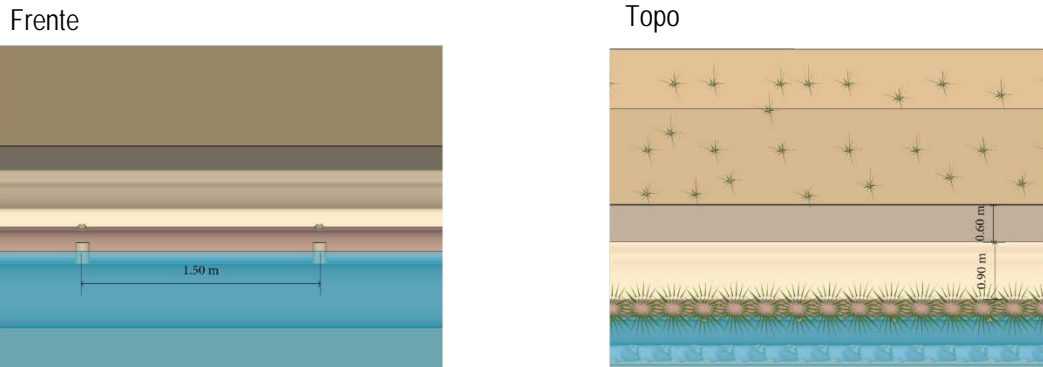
Pormenor de estabilização das margens do lago, vistas de frente e de topo. (Sem escala).
